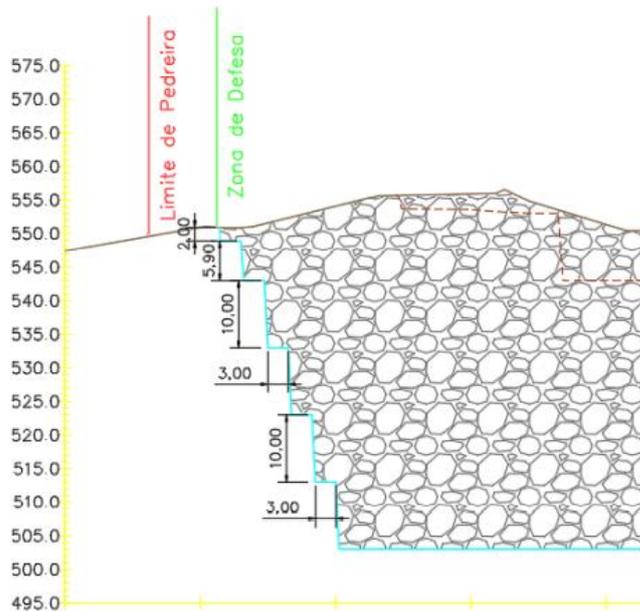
Configuração das bancadas. Fonte: Plano de Pedreira
